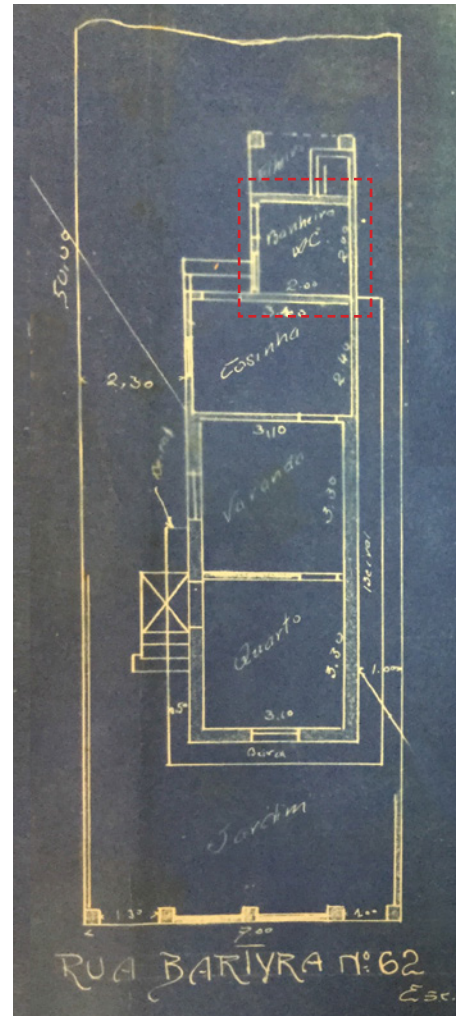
e 3.23 Plantas com cômodo sanitário tipo “B”.
